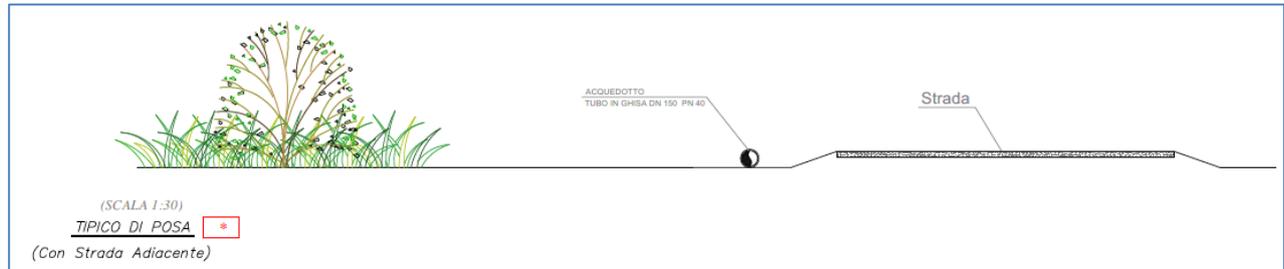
Tipico posa acquedotto (caso con strada adiacente)
